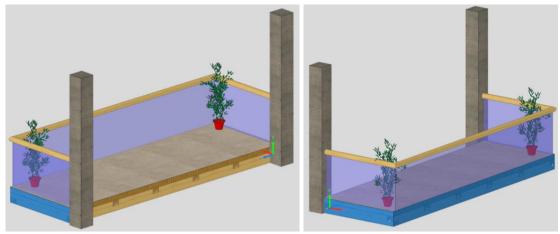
Alternativa 2 –balcón anclando a pilares existentes de hormigón
